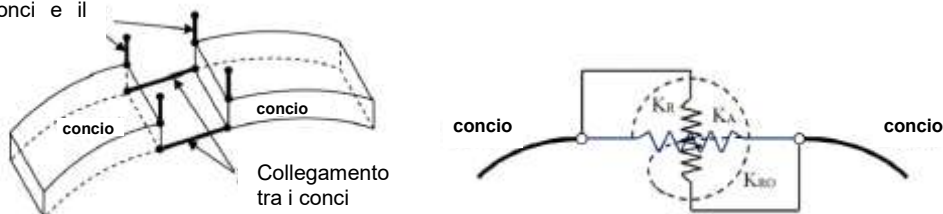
Schema di connessione del giunto (Do et al., 2013)
